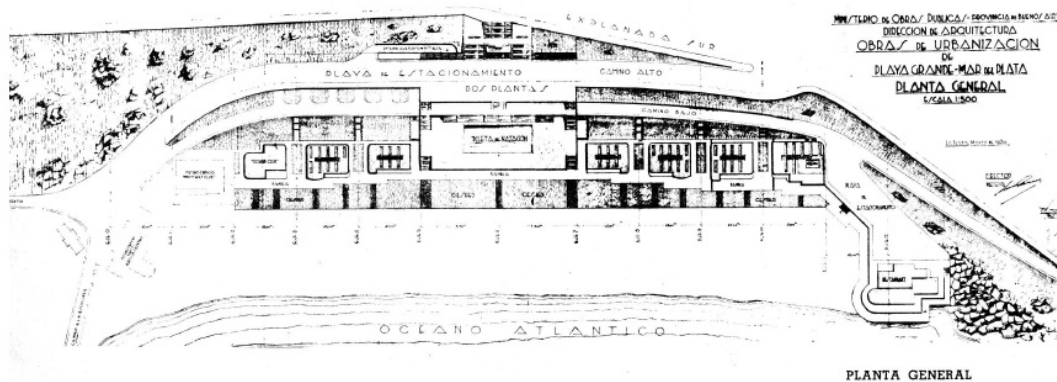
Planta general de conjunto. Ministerio de Obras Públicas. Escala 1:500. Fuente: Revista de Arquitectura, abril 1939.
